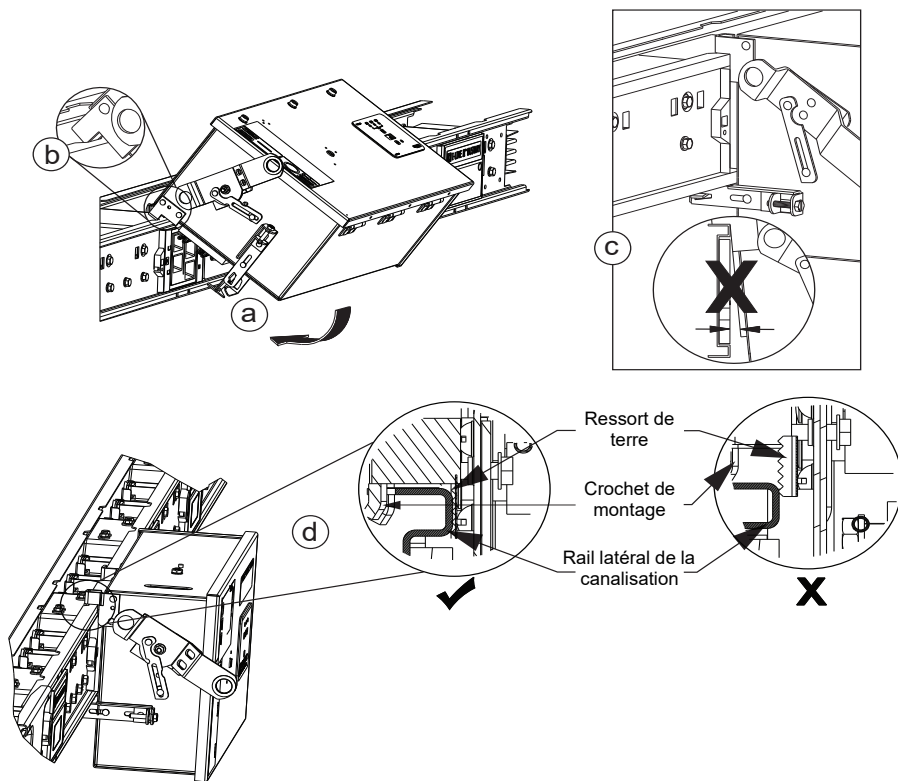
Ouverture de la porte de la canalisation préfabriquée et localisation de l'emplacement du cran de montage
